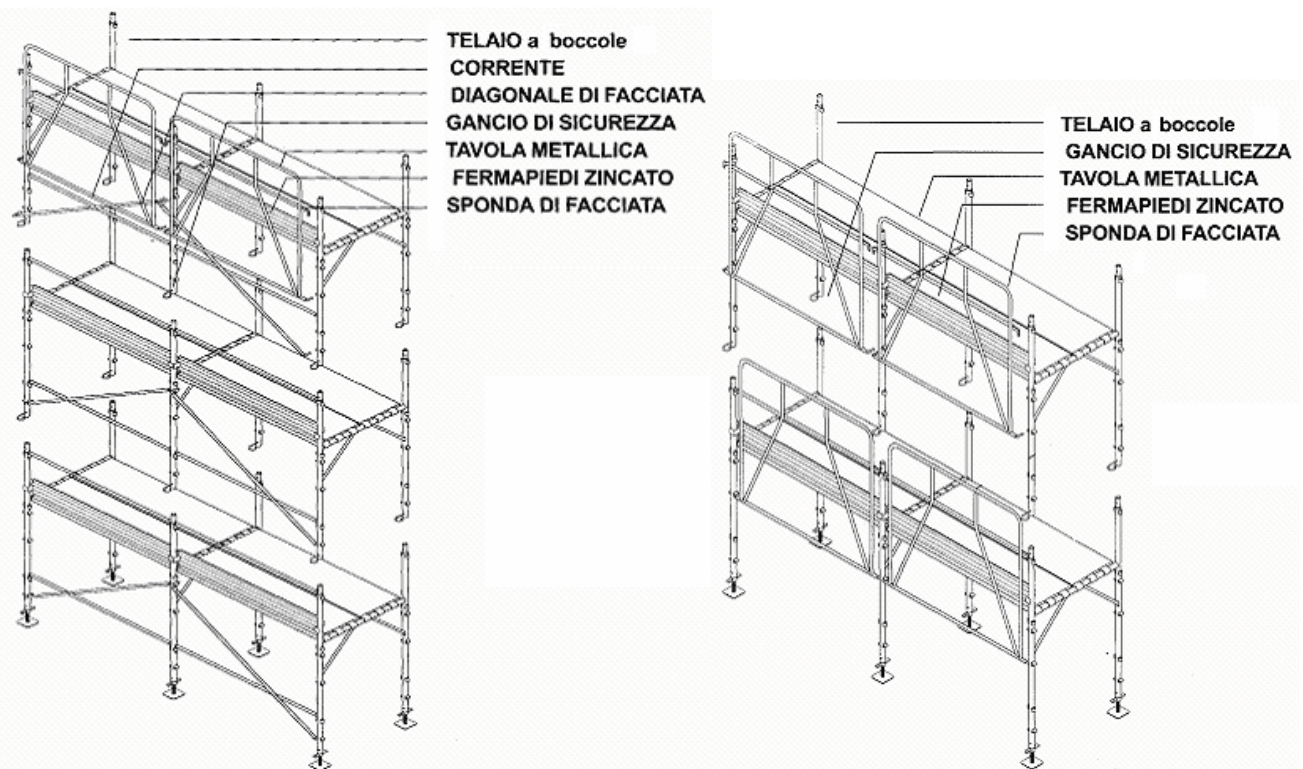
Esempio di montaggio dal basso di parapetti di protezione collettiva
